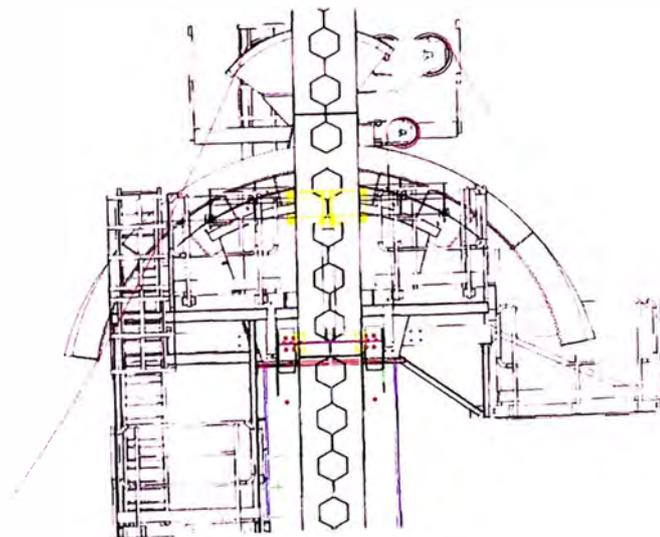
ESQUEMA DEL TRASLADO DE CABLE DEL WINCHE POR EL PILÓN CANAL MARGEN IZQUIERDO
